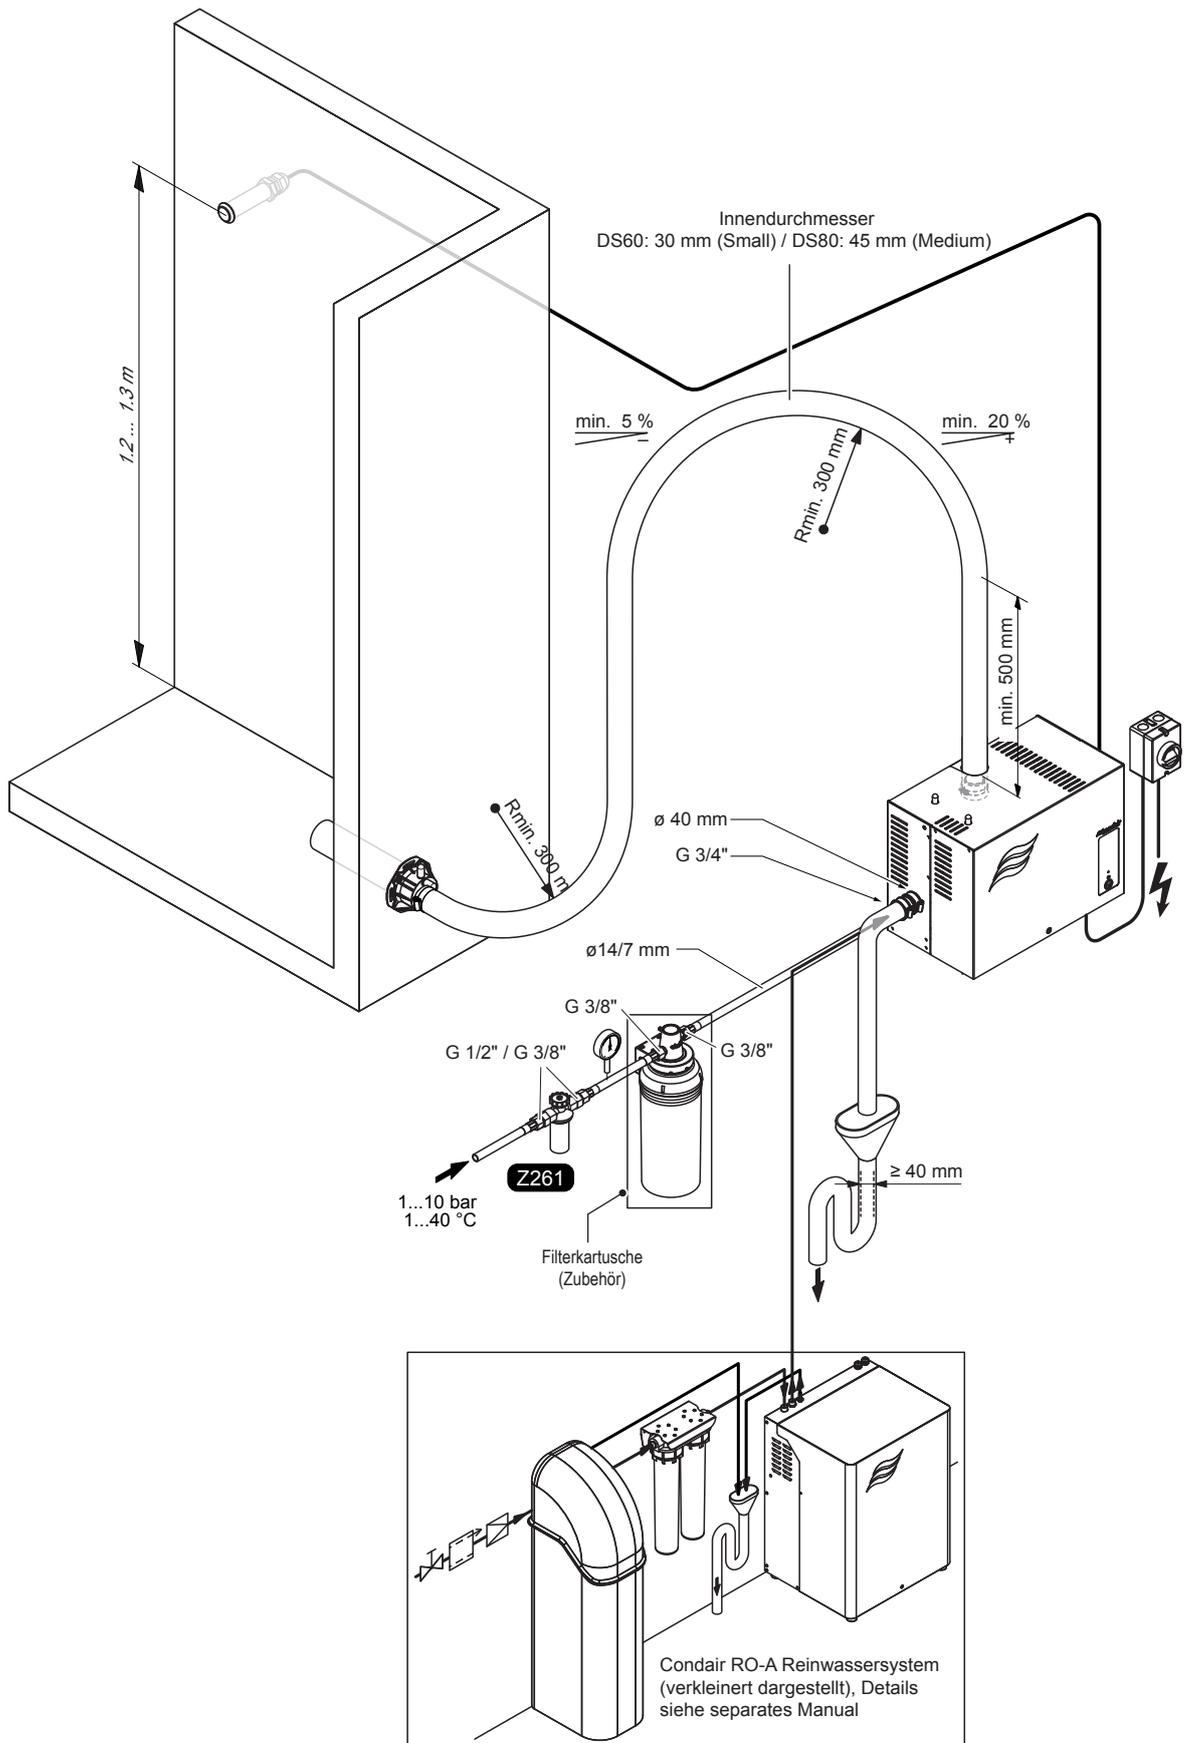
Installationsübersicht (Ausführung mit seitlichem Wasserzu- und ablaufanschluss)
